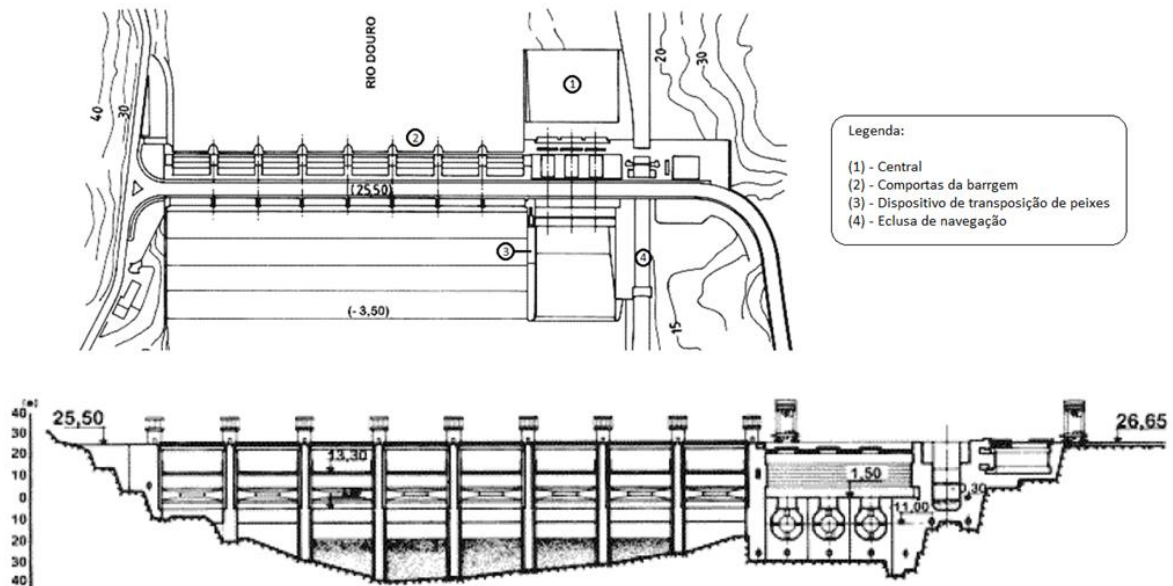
Planta geral do aproveitamento e corte longitudinal [5]
